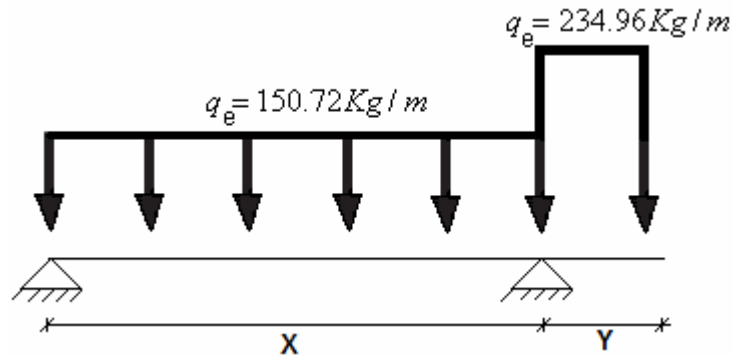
Fuerzas a considerar en pared AA-575 montada.
